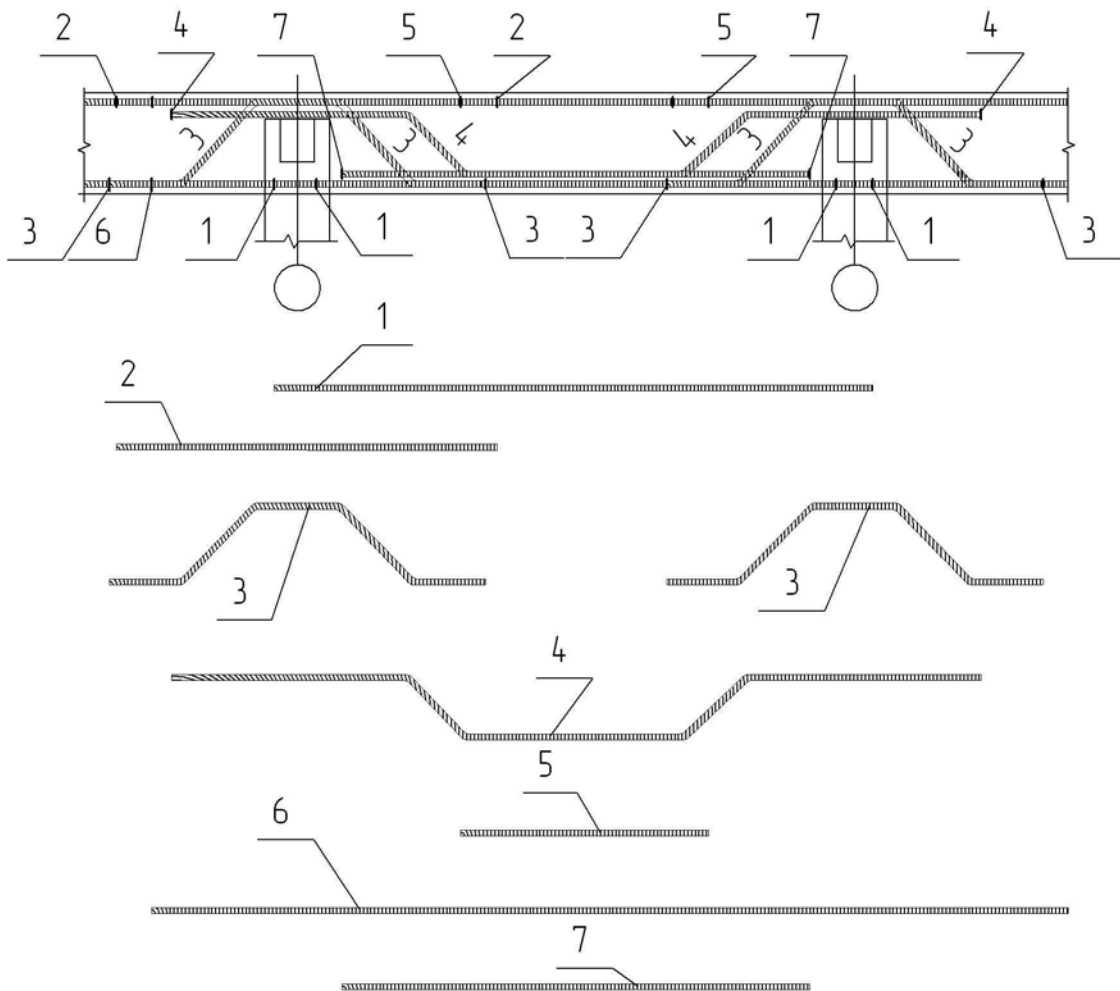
Пример нанесения номеров позиций арматурных стержней на схеме армирования монолитной балки
